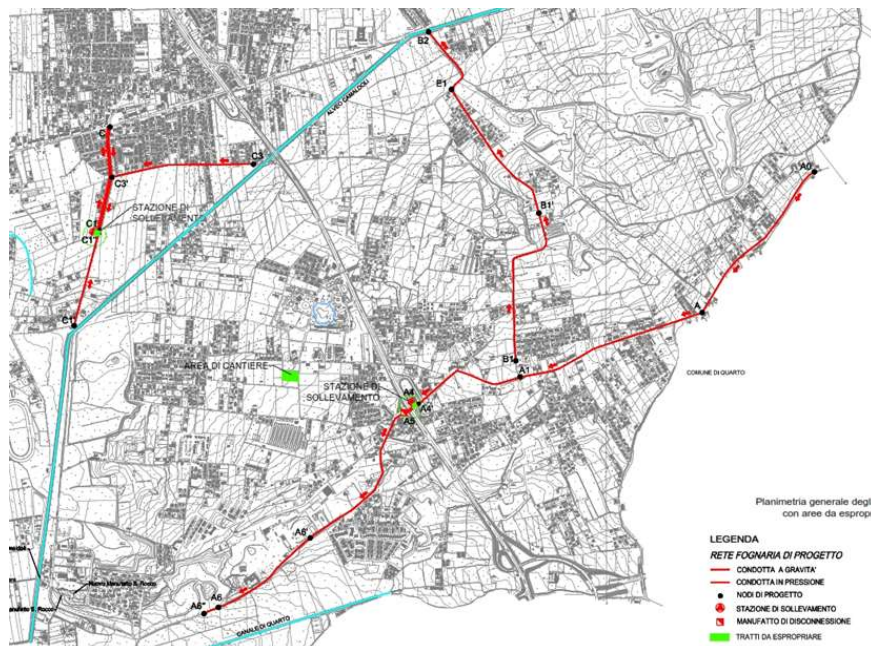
Planimetria degli interventi – Progetto Definitivo 2019
